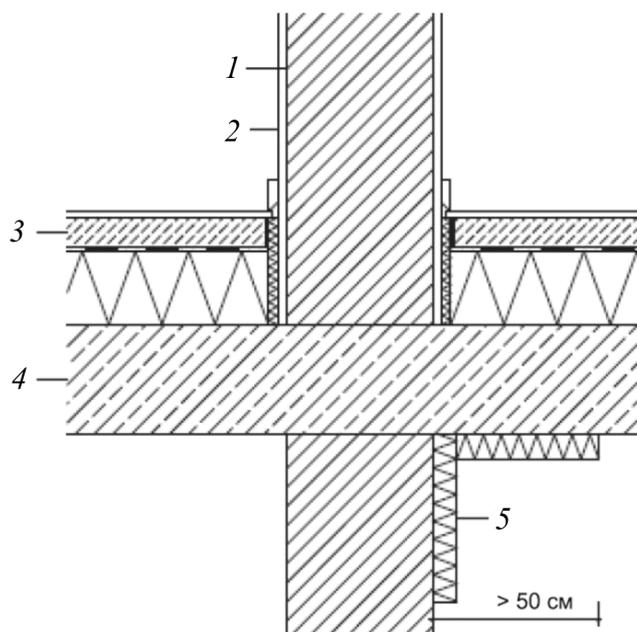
Схема утепления стыка перекрытия с внутренней разделительной стеной: 1 – внутренняя стена; 2 – внутренняя штукатурка; 3 – пол с плавающей стяжкой; 4 – бетонное покрытие; 5 – дополнительная теплоизоляция стыка перекрытия с внутренней разделительной стеной [2]
